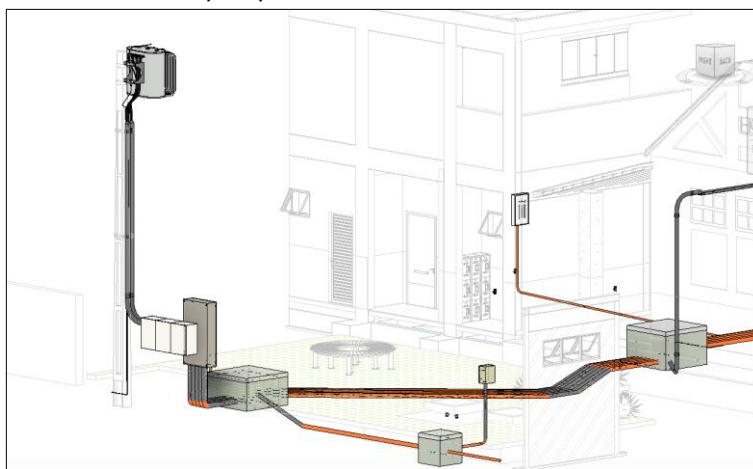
Vista em planta baixa da modelagem dos alimentadores
